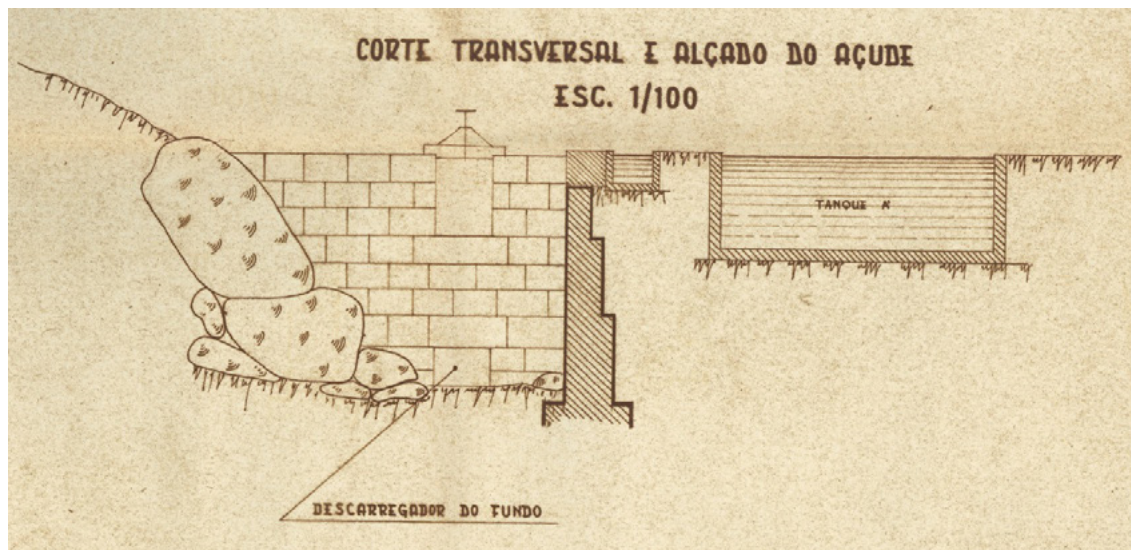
Corte transversal e alçado do açude a construir. Escala 1:100. Fonte: Arquivo APA.
